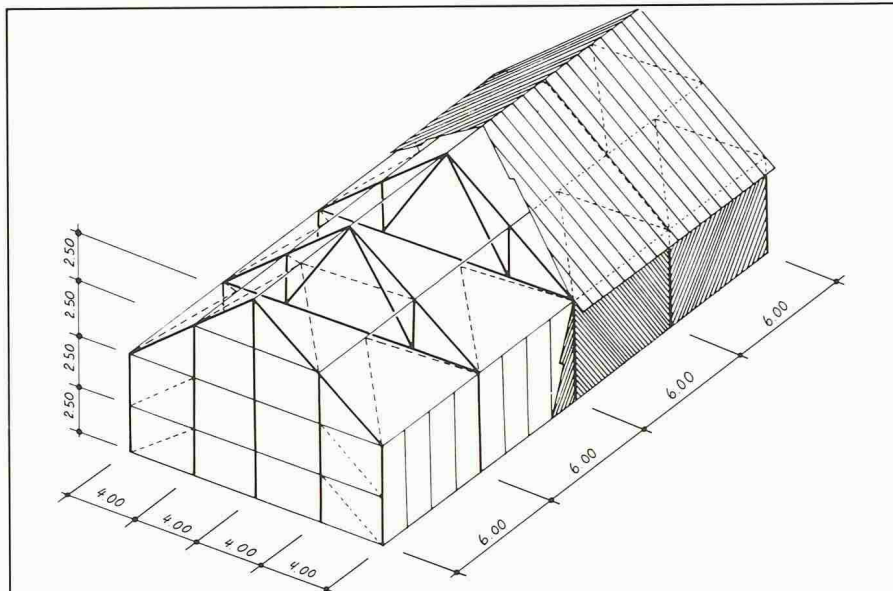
Testobjekt 1: Grunddaten einer Holzkonstruktion
